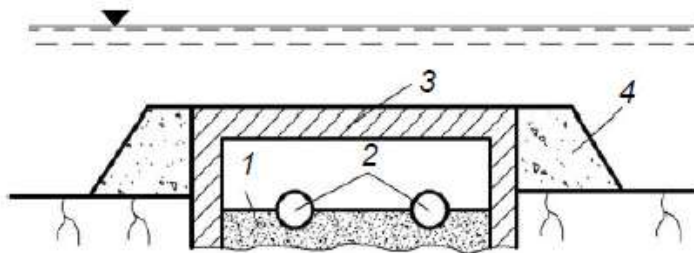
Захист ліній залізобетонними блоками: 1 – піщана подушка; 2 – самопливні лінії; 3 – залізобетонний блок; 4 – насип з каміння
